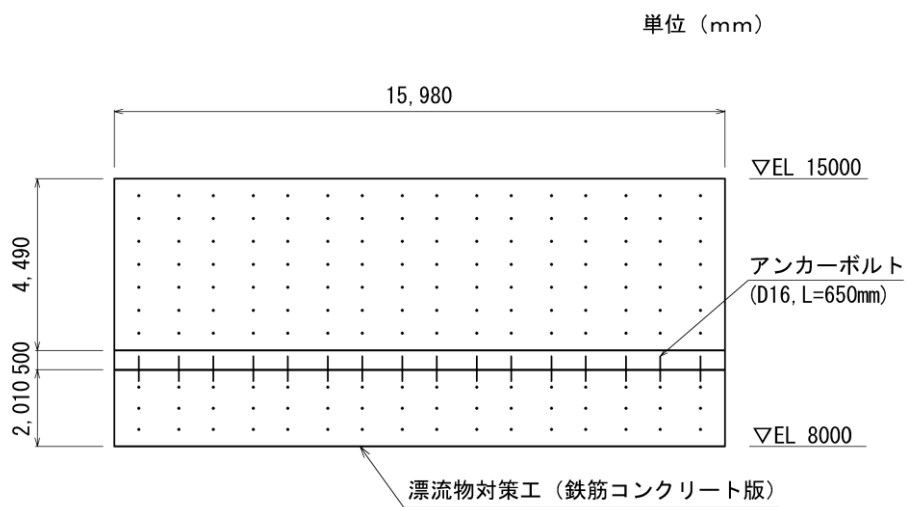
(1) 漂流物対策工 (鉄筋コンクリート版) のアンカーボルト配置図 (正面図)
